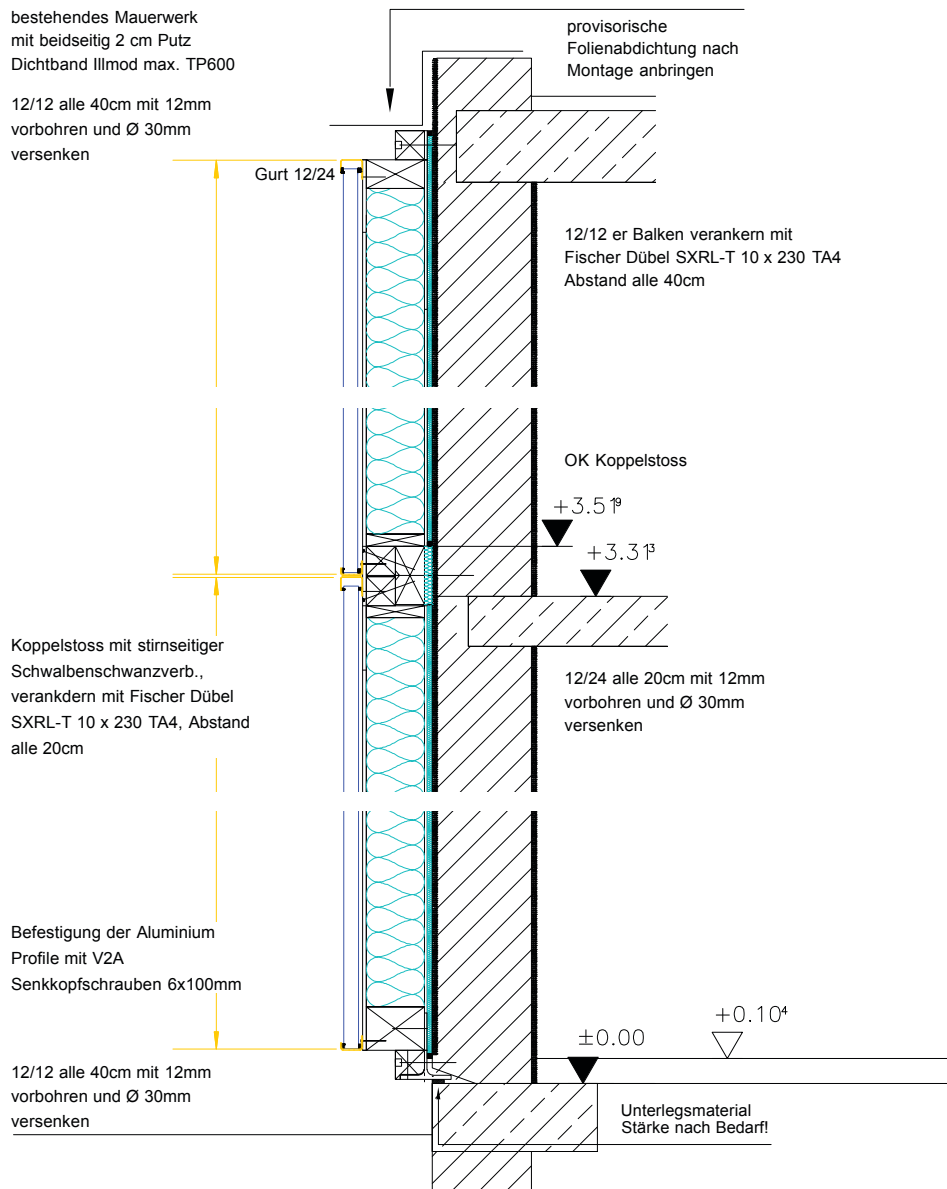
Fassadenschnitt Holzständerelemente Werkstattplanung (Zeichnung: BAUFRTZ)
